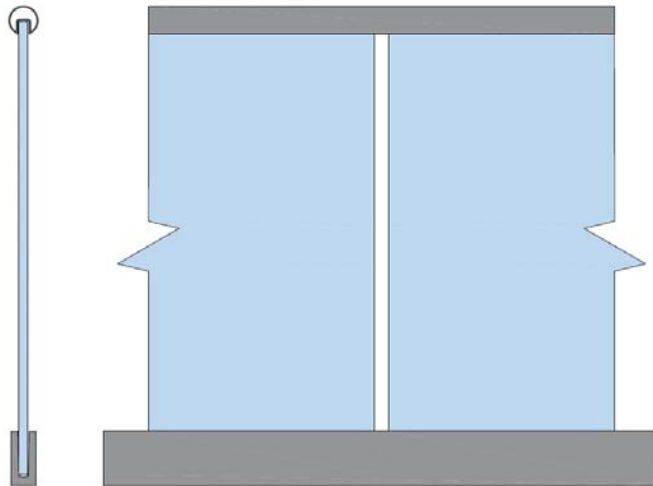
Variante β : Ausführung mit durchgehendem Handlauf
